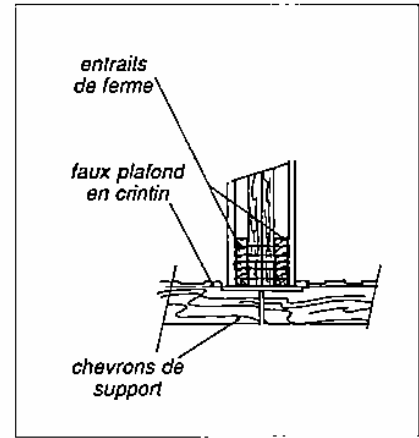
Détail A (fig. 291) de support de faux plafond. La sous-face des entrails des différentes fermes de charpente permet de fixer un support de faux plafond en sections de chevrons.
